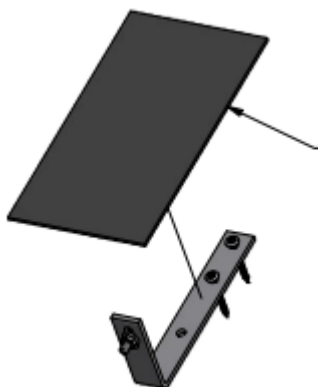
příklad instalace svorky pro střechy se stojatou drážkou
